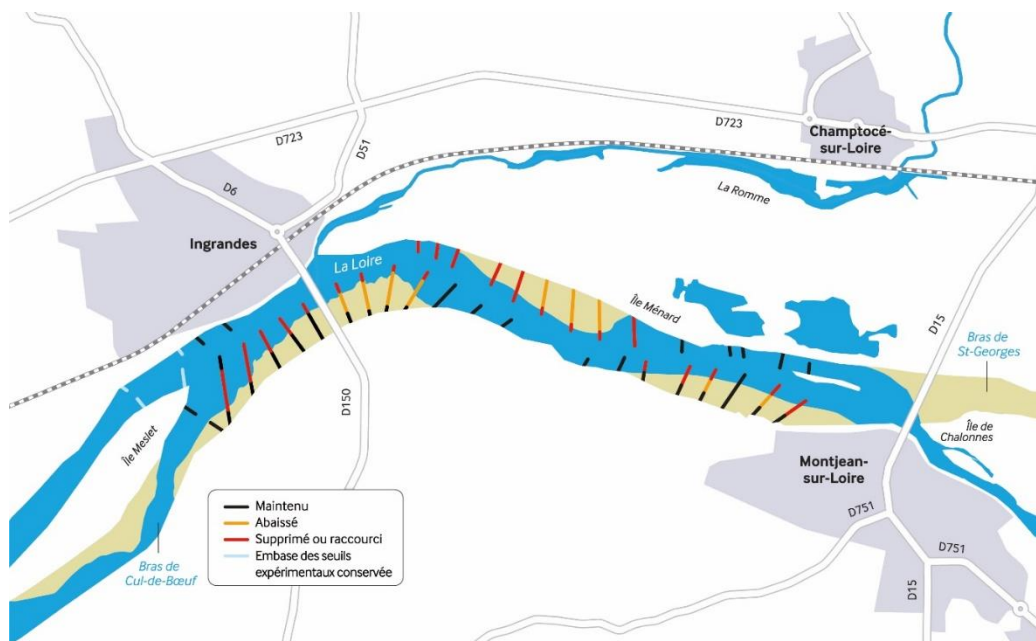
Plan des travaux du secteur A à Ingrandes/Montjean-sur-Loire
